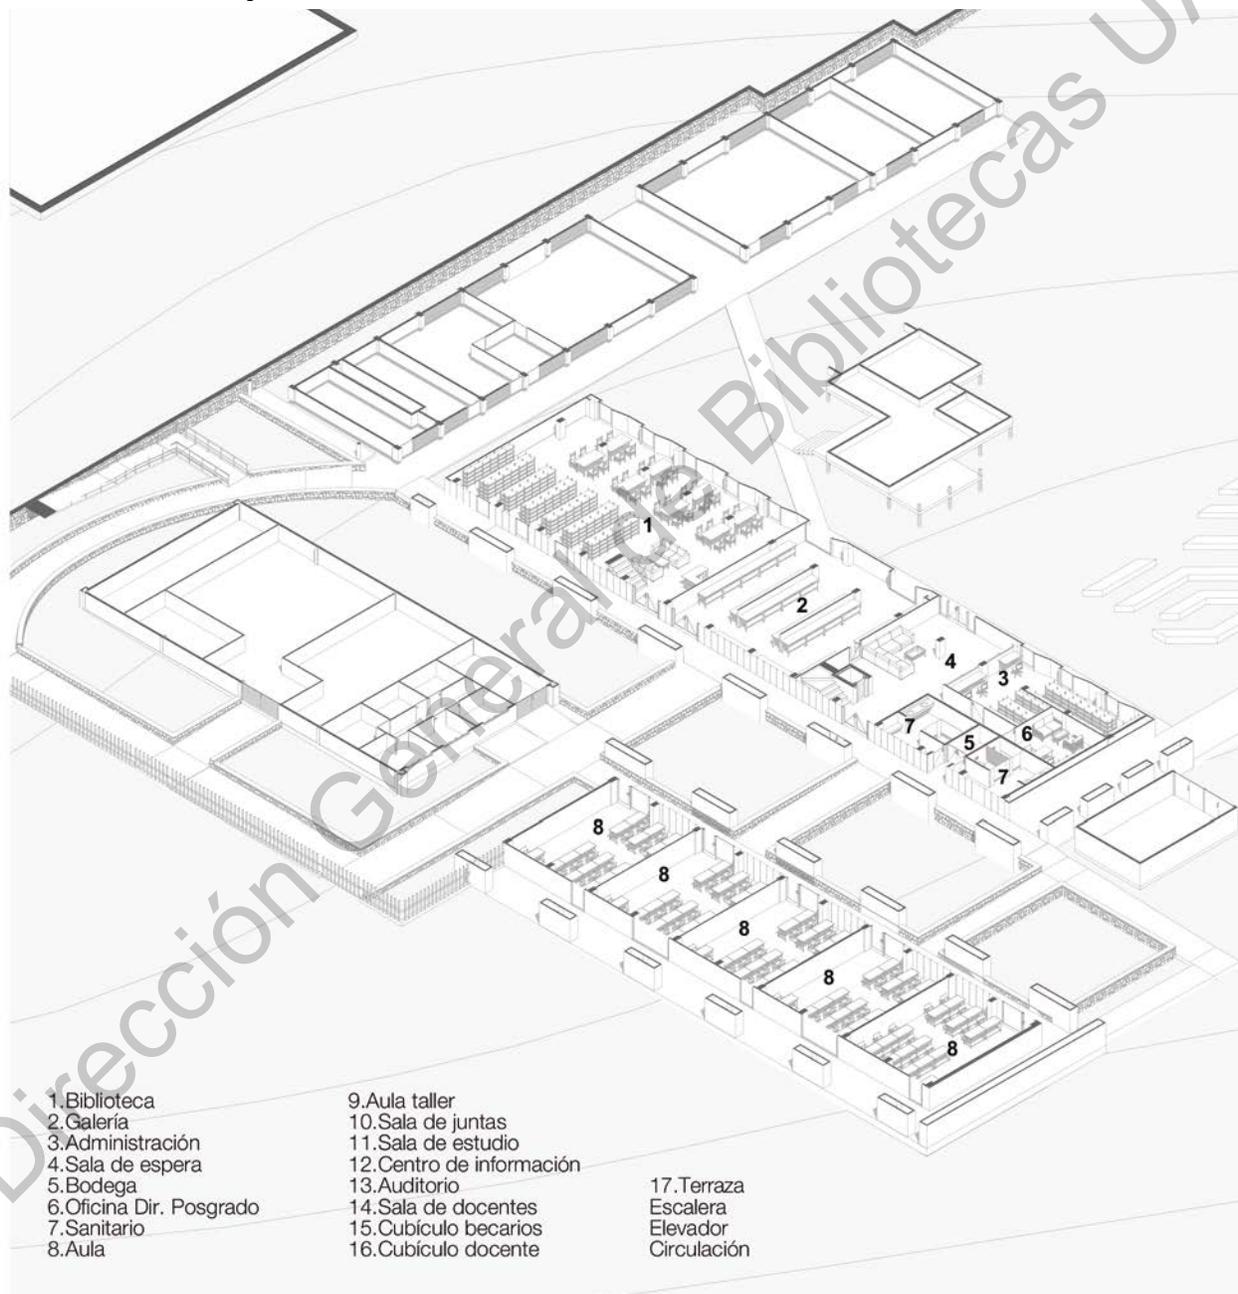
Axonométrico de Planta Baja (Elaboración propia).
